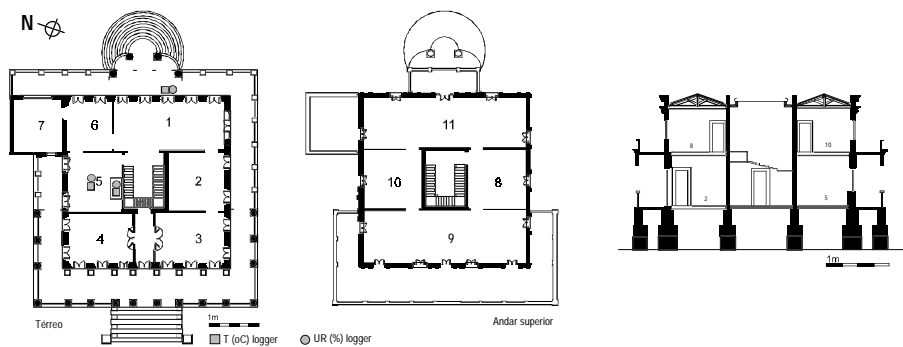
plantas-baixas e corte do MEP, mostrando o local dos aparelhos medidores.
